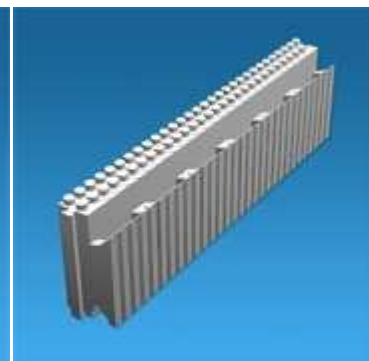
Elemento de fecho de laje (ARGISOL, 2010).
